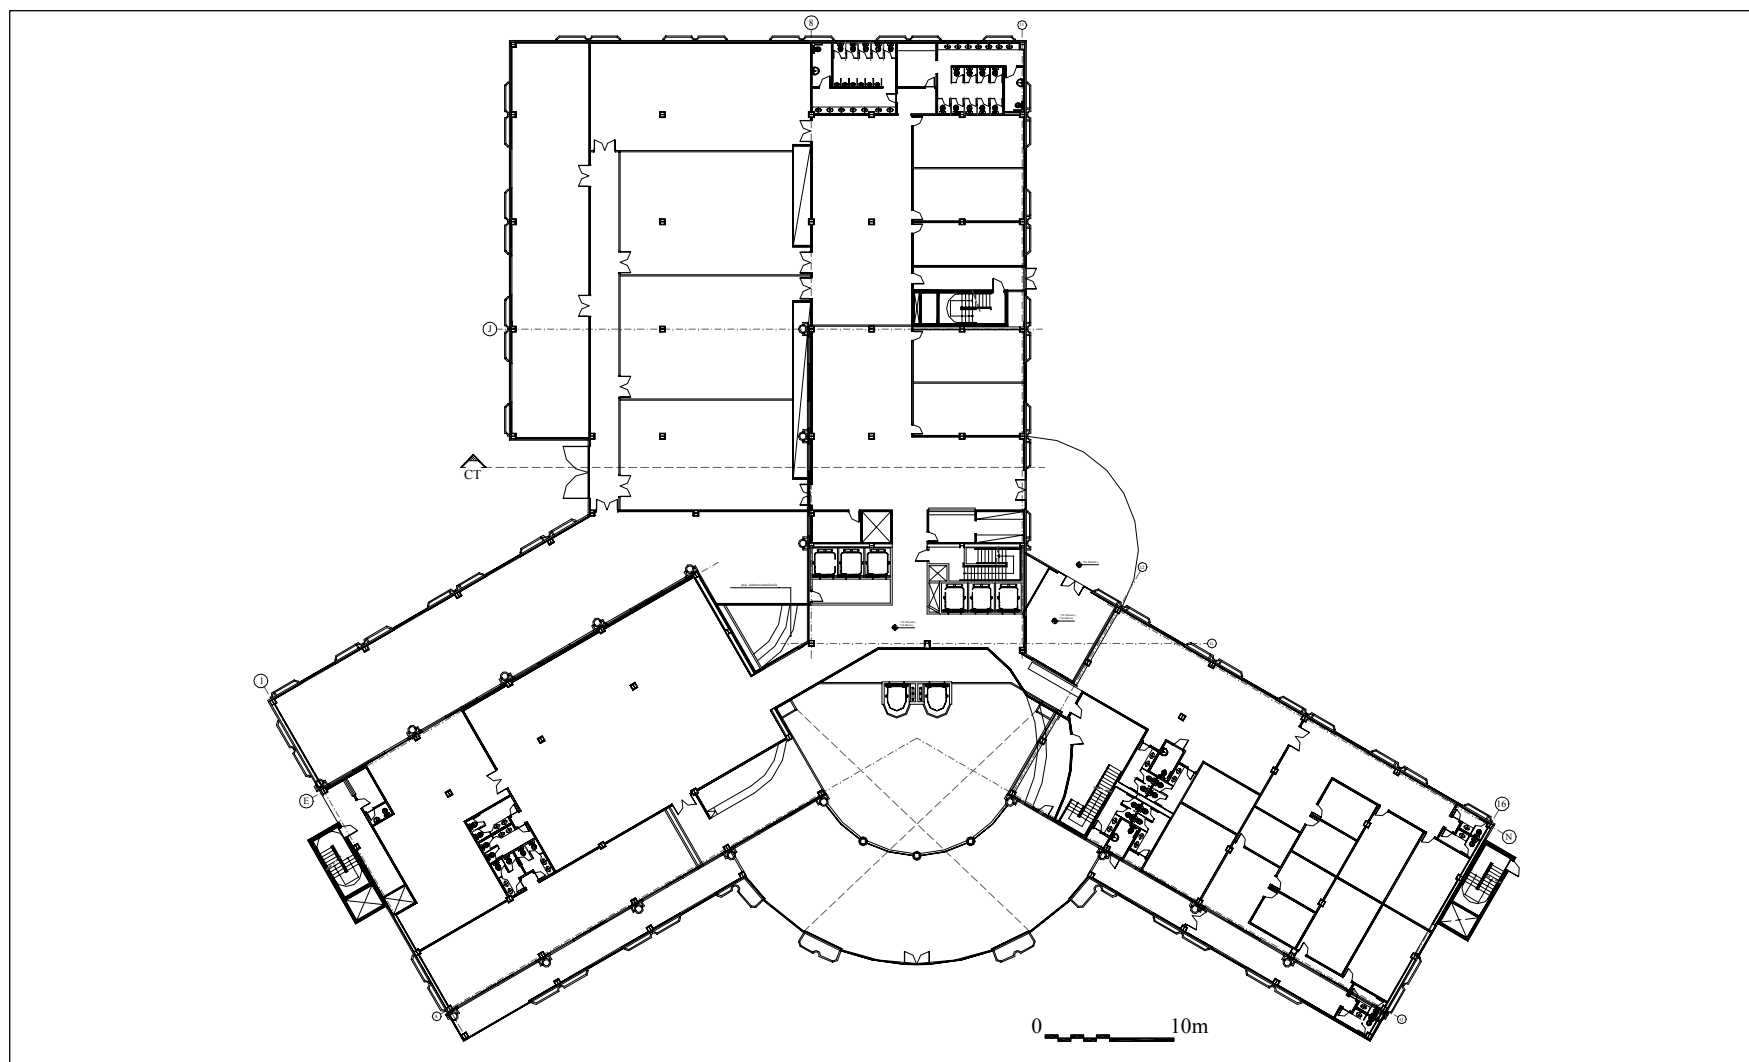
Solução arquitetônica do edifício E-1: esboço da planta do primeiro pavimento.
